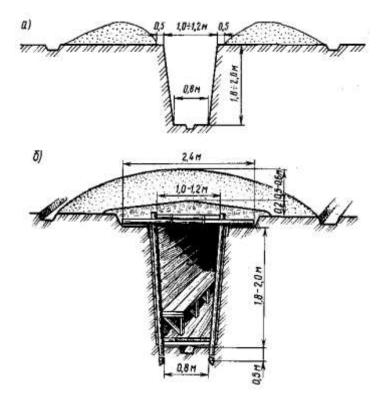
Открытая щель (а), перекрытая щель (б).
